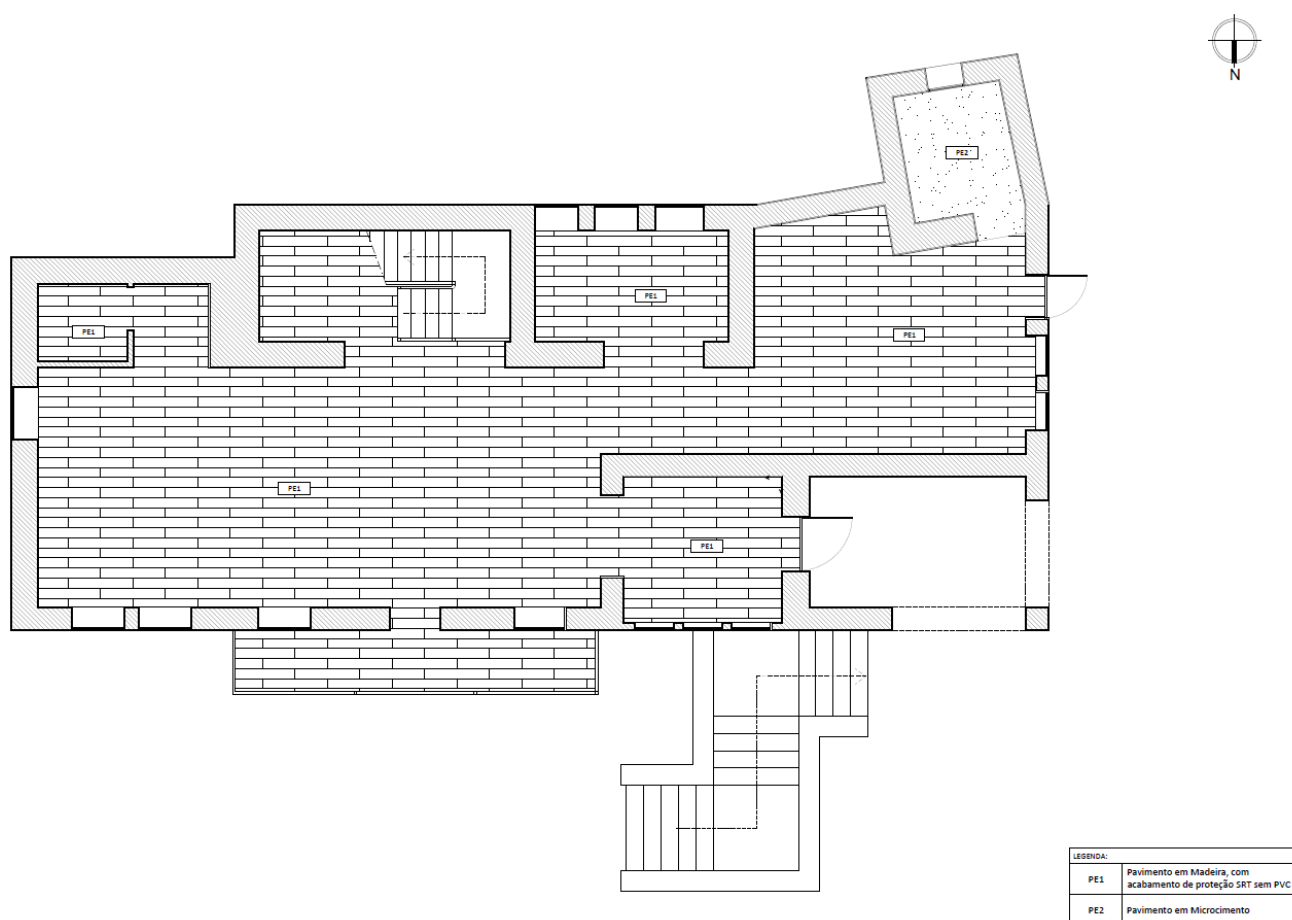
Planta de Pavimentos, Alojamento Loureiro, Piso 0.
